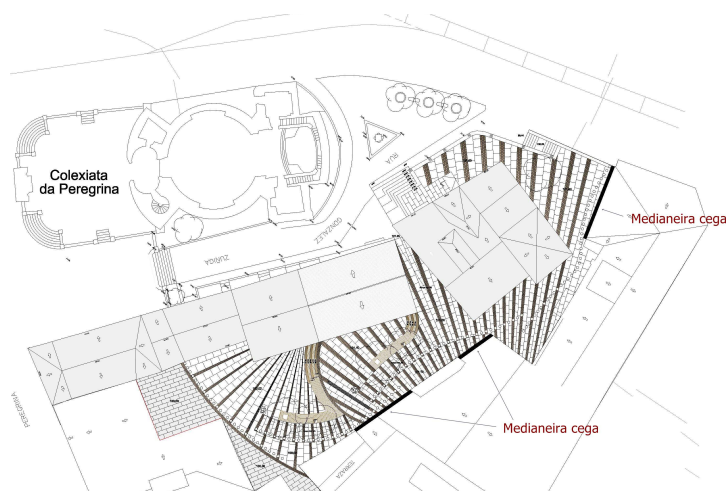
Planta da proposta onde se indican as zonas das medianeiras cegas
